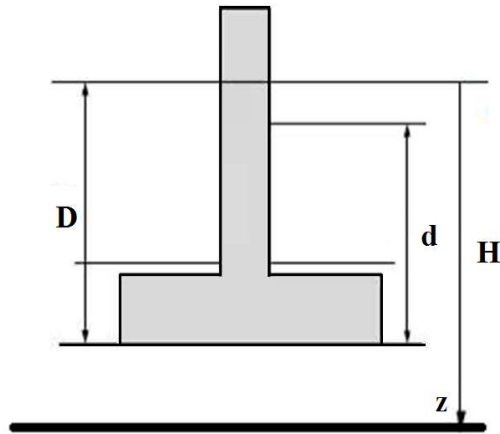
Exemple d'un poteau reposant sur une semelle.
